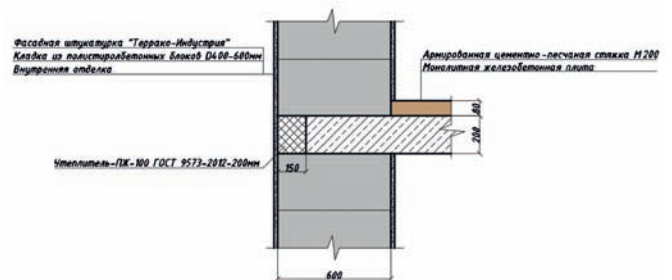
Проектное решение узла примыкания наружной стены из ПСБ-блоков к междуэтажному перекрытию. Составлено авторами согласно проекту
